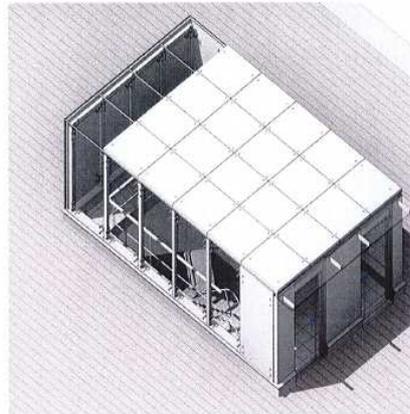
Tipologico torrino a doppia rampa: vista tridimensionale
